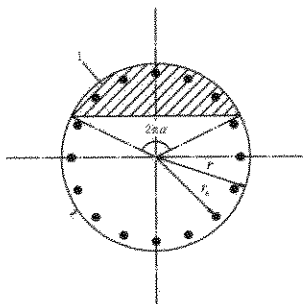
沿周边均匀配置纵向钢筋的圆形截面
